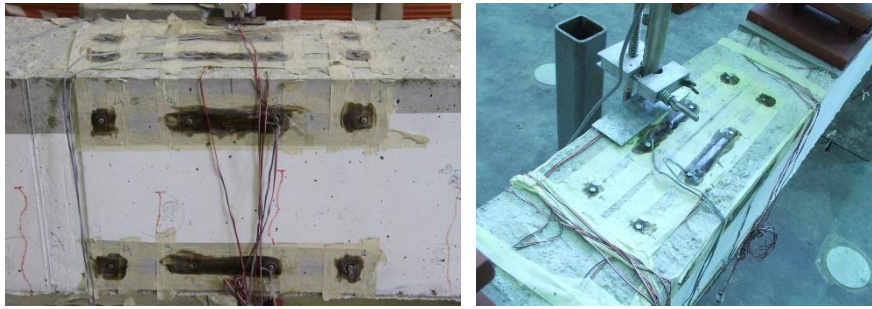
Galgas de hormigón y discos metálicos en el hormigón. Fase Vigas II
